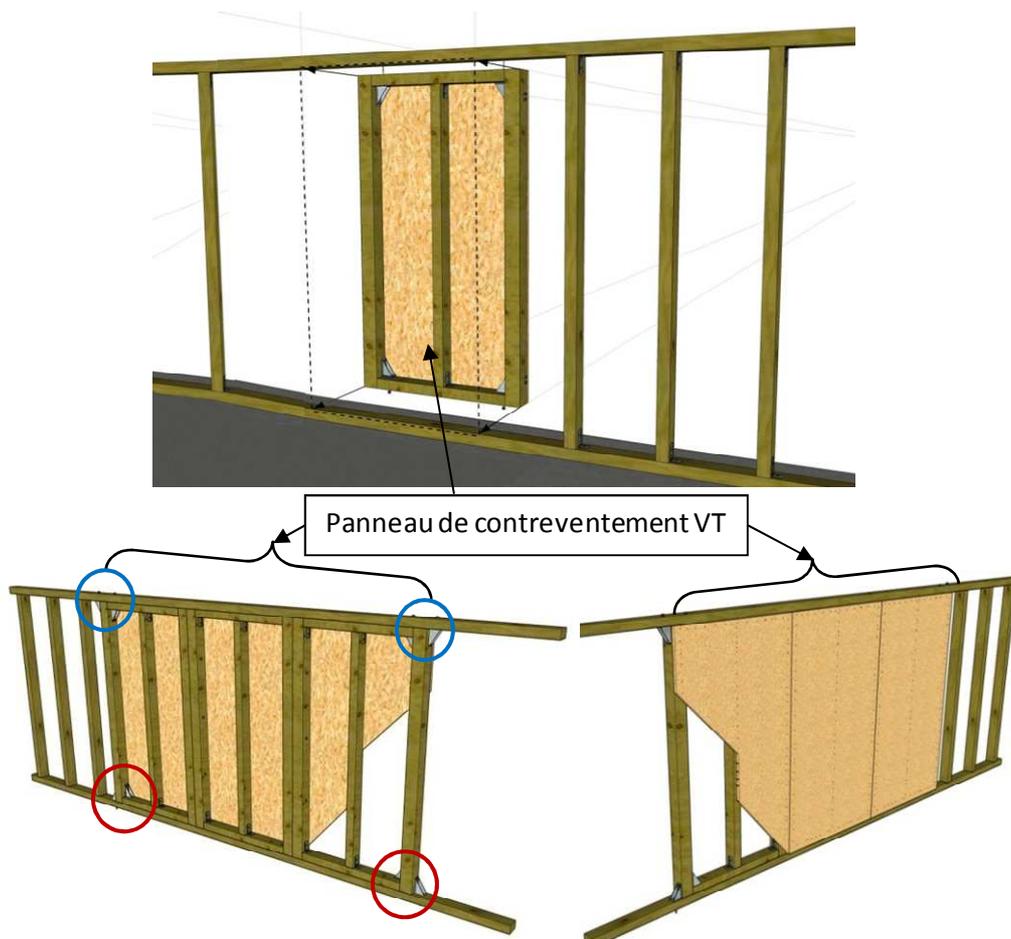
Mise en place de panneaux VT, fabriqués en usine ou atelier, dans un mur de façade existant (en haut mur comportant un seul panneau VT isolé, en bas mur comportant 3 panneaux VT accolés)
